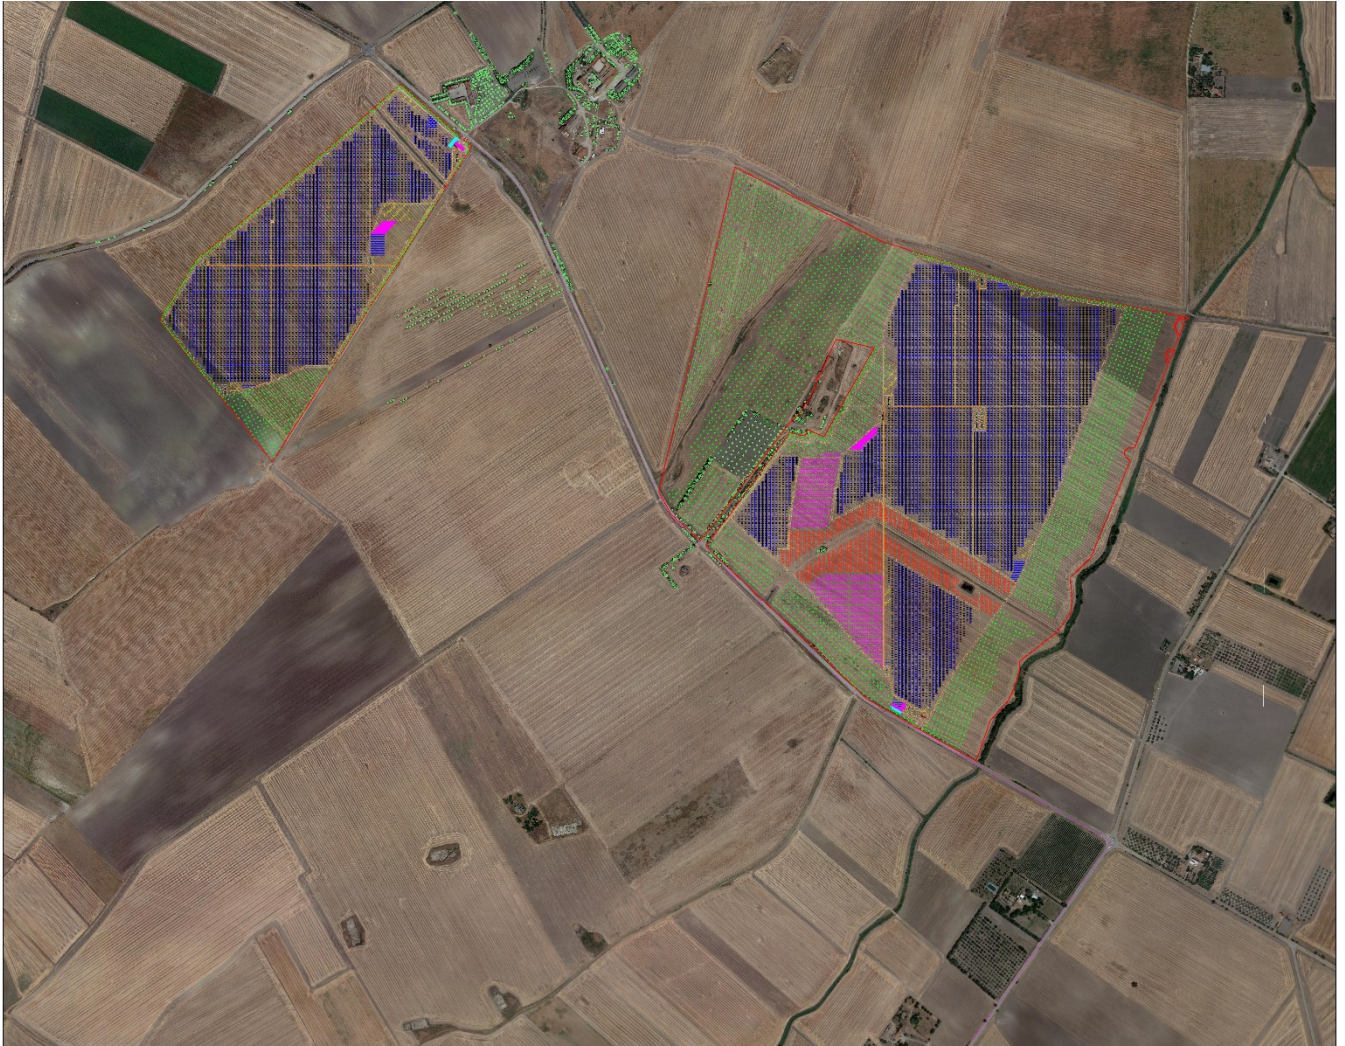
Piano di cantierizzazione con individuazione dei punti di stoccaggio (Tavola D25)
